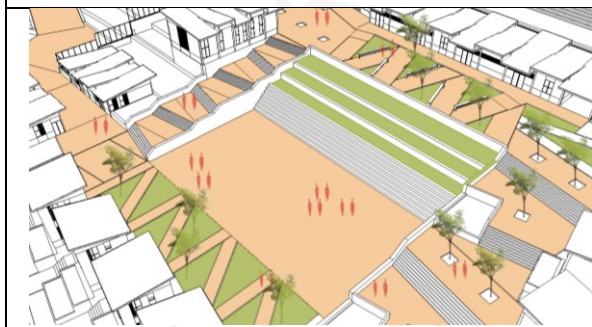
Imagen de la zona donde se ubica la losa deportiva
